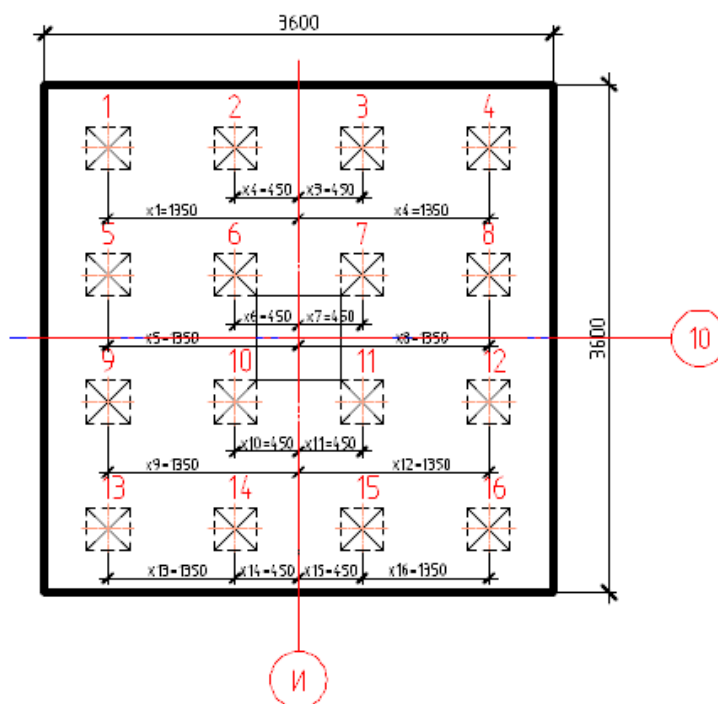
Схема к определению нагрузок на сваю
